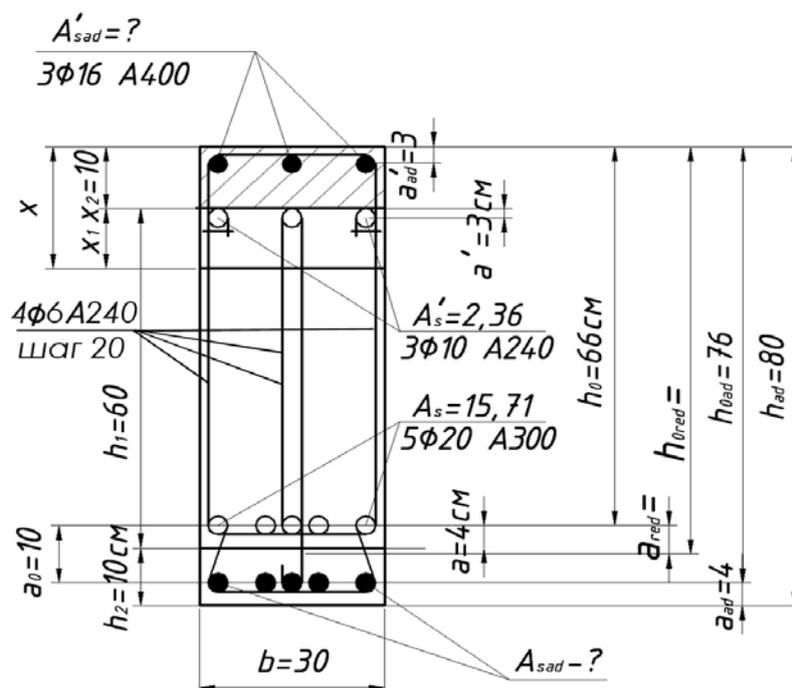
Расчетная схема усиления элемента прямоугольного профиля двухсторонним наращиванием.
